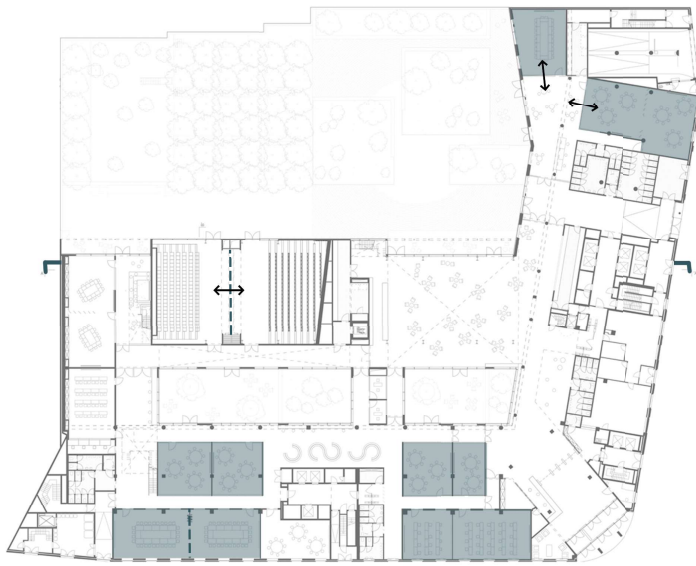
Diagrama de análisis espacial sobre plano de la planta baja.
